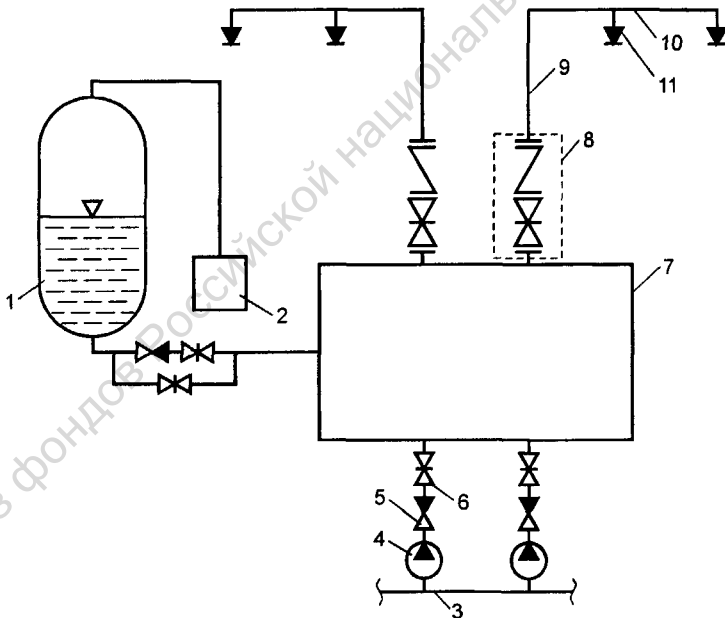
Схема автоматической спринклерной установки водяного пожаротушения: 1 – импульсное устройство; 2 – компрессор; 3 – водоисточник; 4 – основной и резервный насосы; 5 – обратный клапан; 6 – задвижка; 7 – подводящий трубопровод; 8 – КПУ; 9 – питающий трубопровод; 10 – распределительный трубопровод; 11 – спринклер
